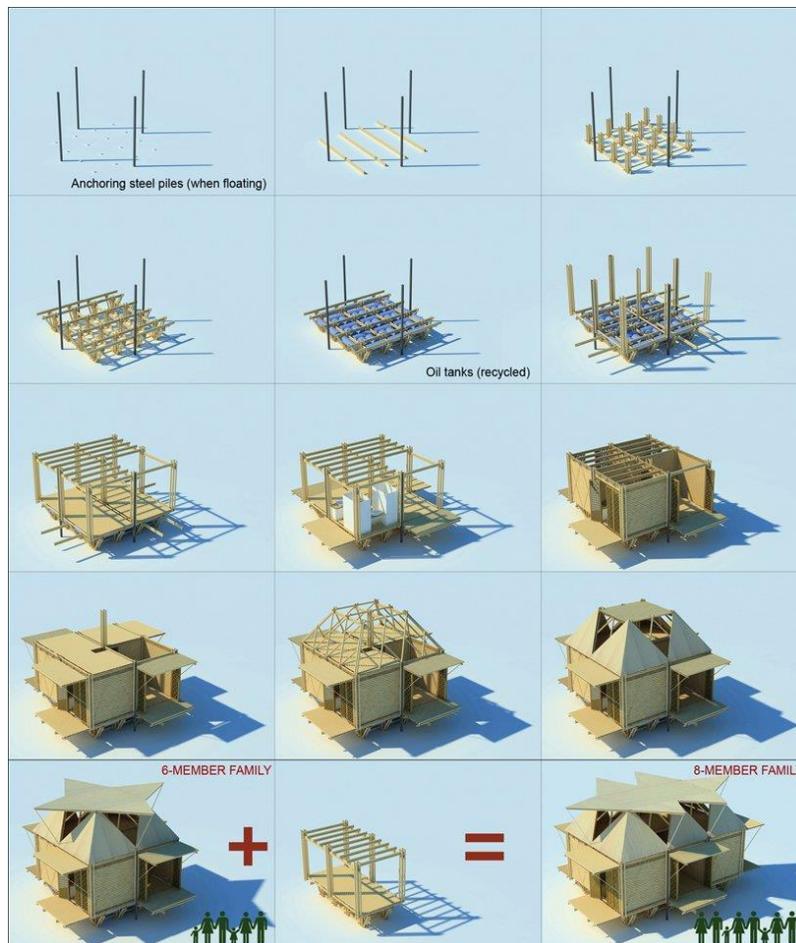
Sistema constructivo de la casa de bambú
